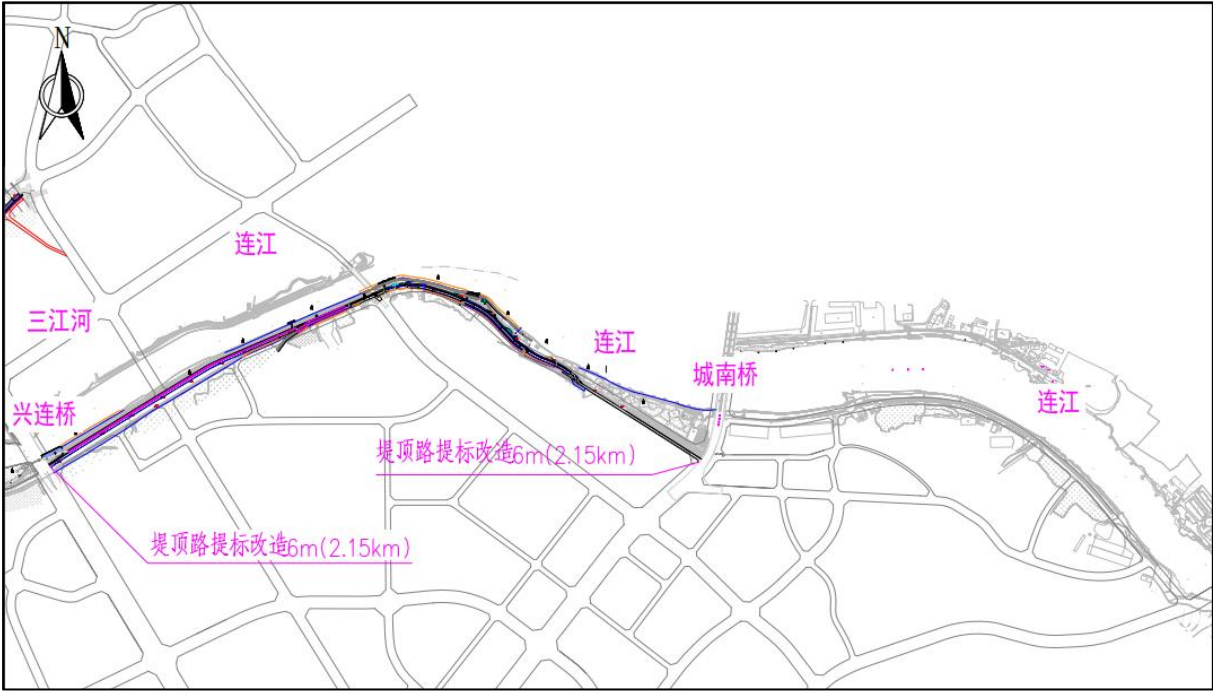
下游段堤顶路升级改造工程平面布置图
